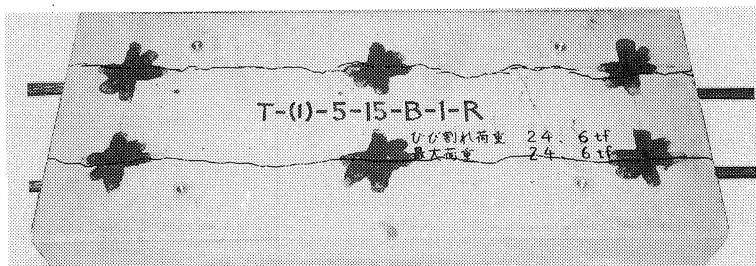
ひび割れ発生状況(PC鋼材方向)
